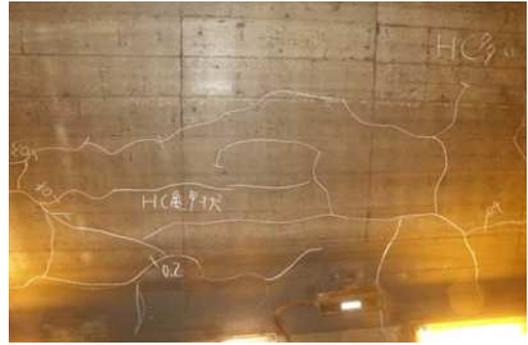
複数のひび割れで覆工コンクリートがブロック化している例¹⁾
